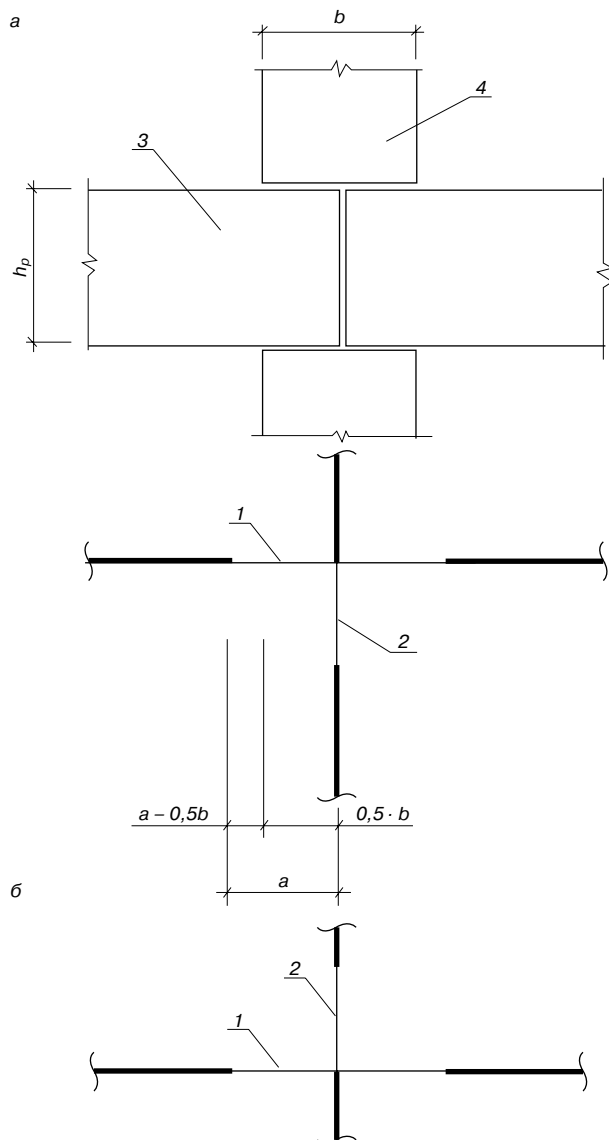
Варианты моделирования: а – примыкание плиты перекрытия к верхнему узлу стержня (рекомендуется), моделирующего платформенный стык; б – то же, к нижнему узлу стержня
